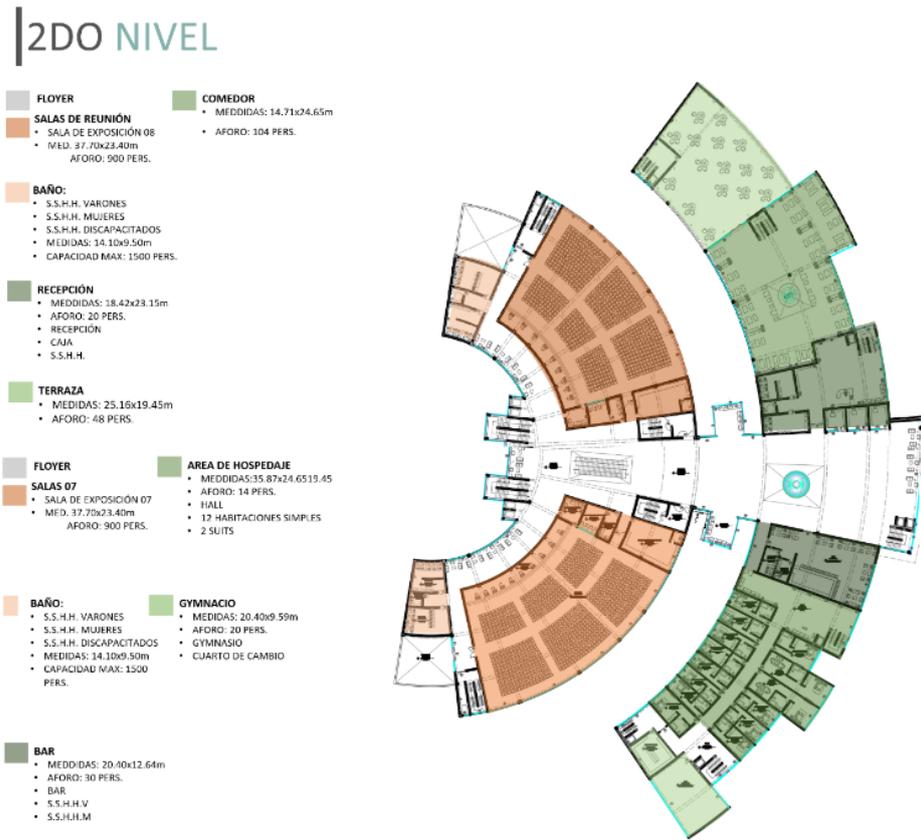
Plano de distribución del segundo nivel: sector 01 y sector 03.
